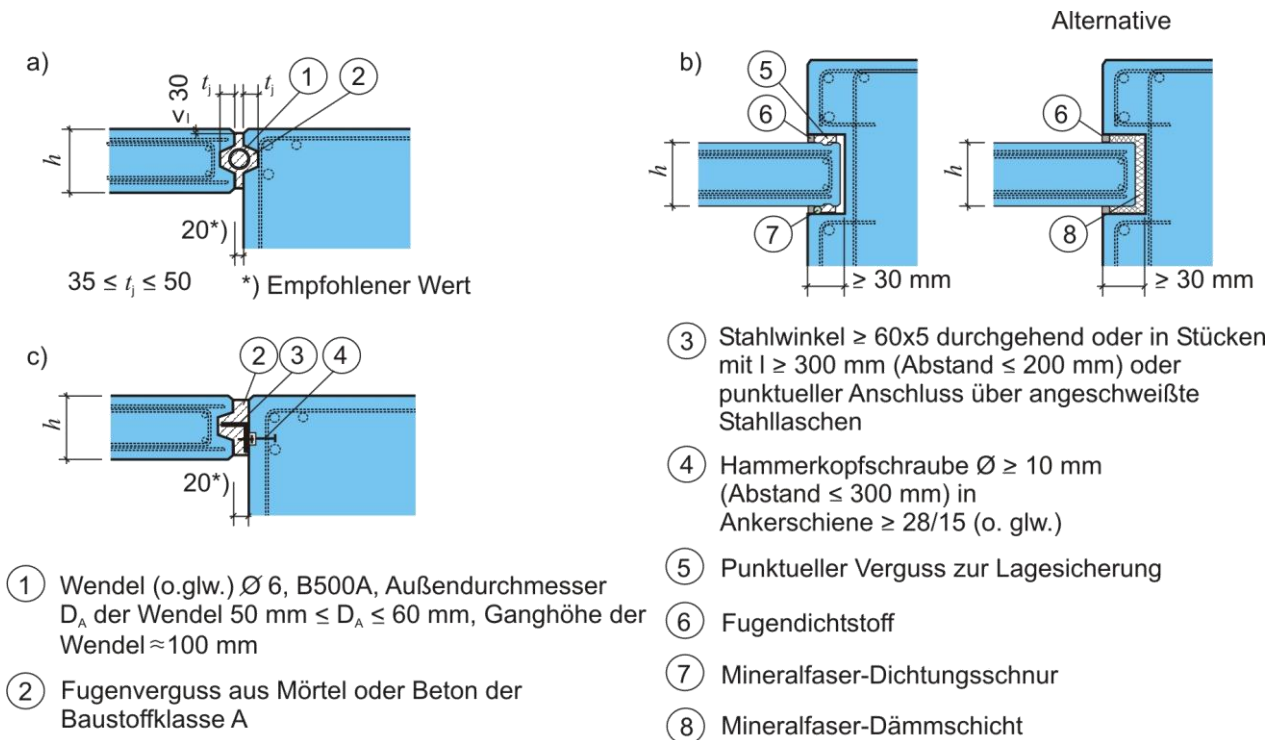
Anschlüsse von Fertigteil-Brandwänden zwischen Stahlbetonbauteilen a) mit Wendel, b) mit Vertiefung, c) mit Stahlwinkel
